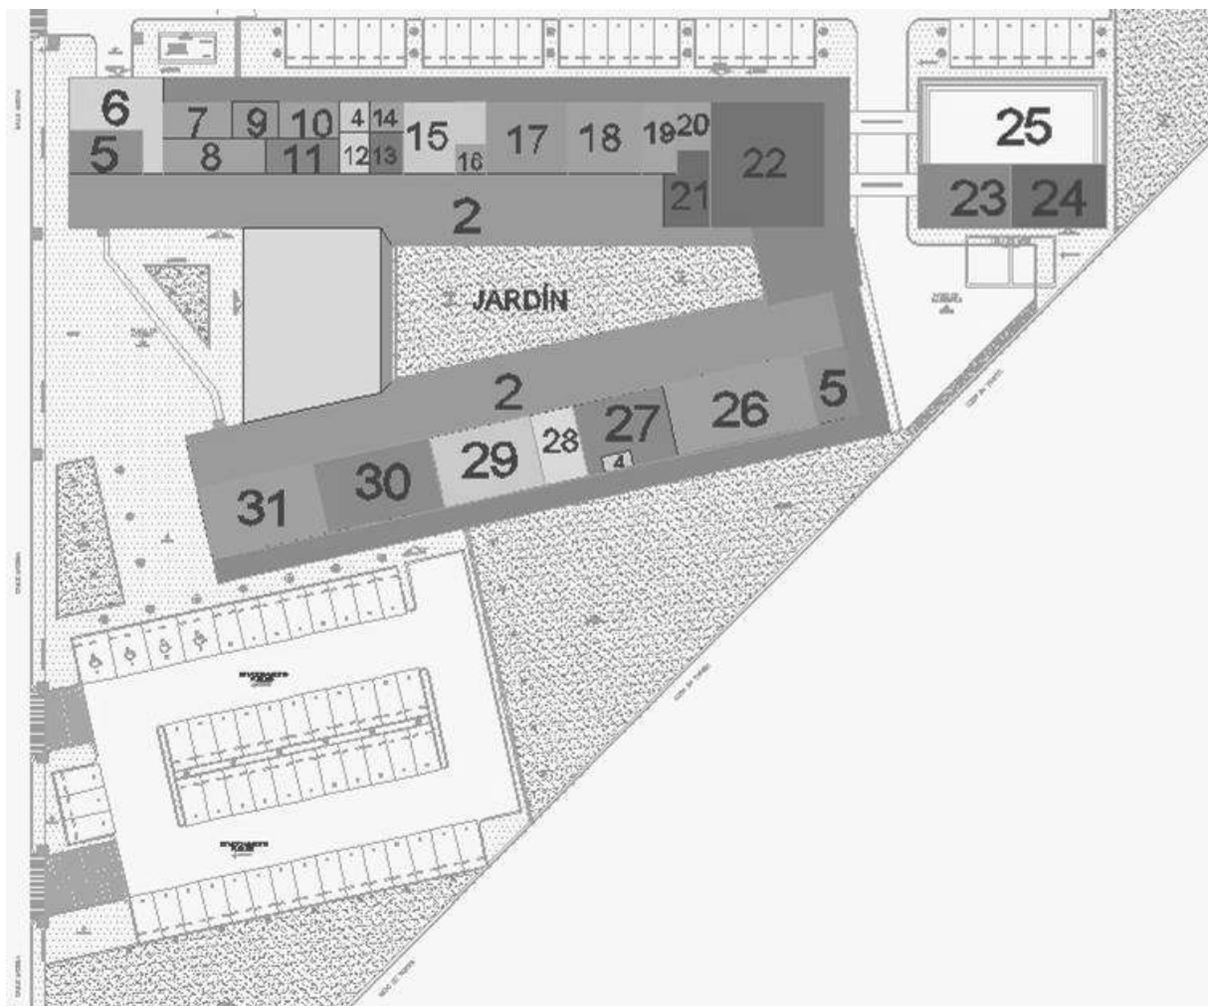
Zonificación planta baja UMF N°81. Elaborada por la autora.
